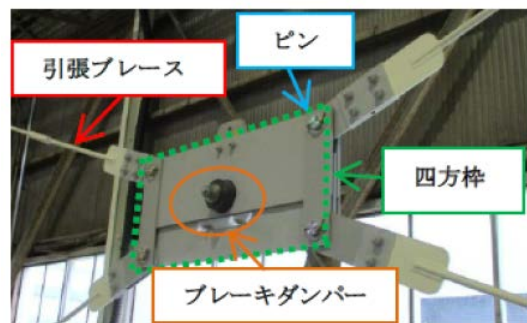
ブレーキダンパー (引張ブレース型) Brake Damper (Tension Brace Type)
